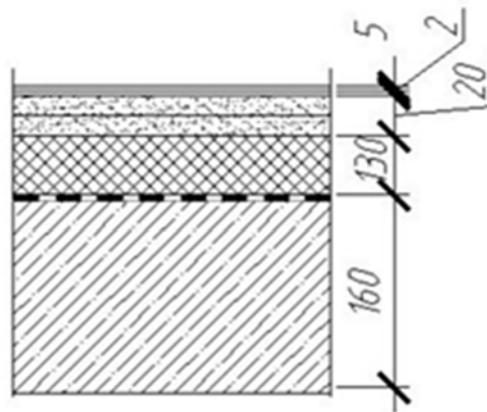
Конструкция перекрытия над неотапливаемым техподпольем
